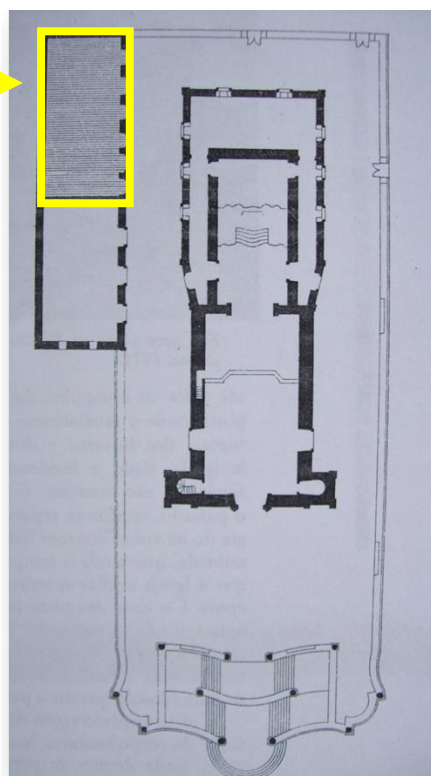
Planta Baixa | Sala dos Milagres.
